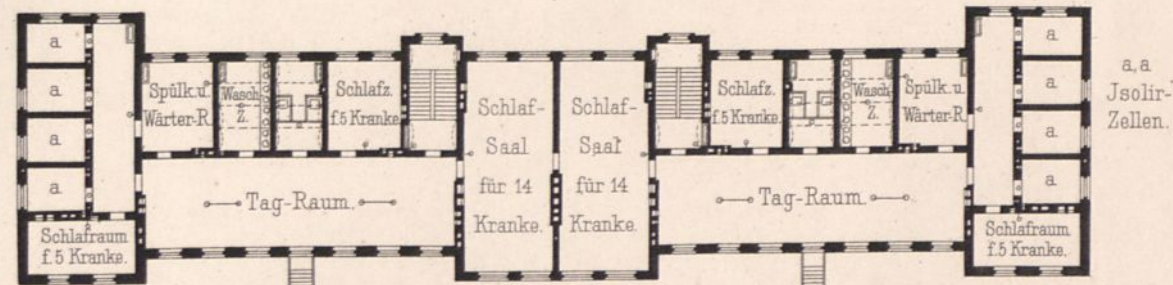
Krankenhaus C. Grundriß des Erdgeschosses.
